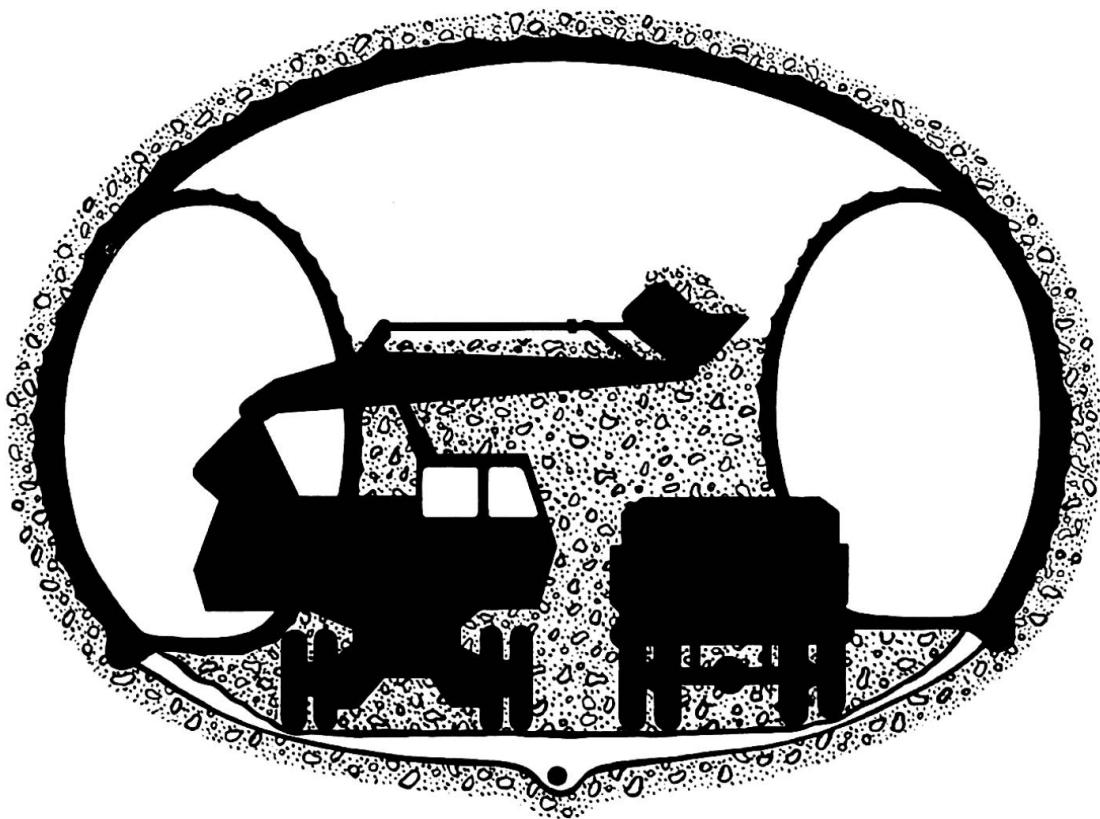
Gerätedisposition für einen mehrgleisigen Querschnitt
